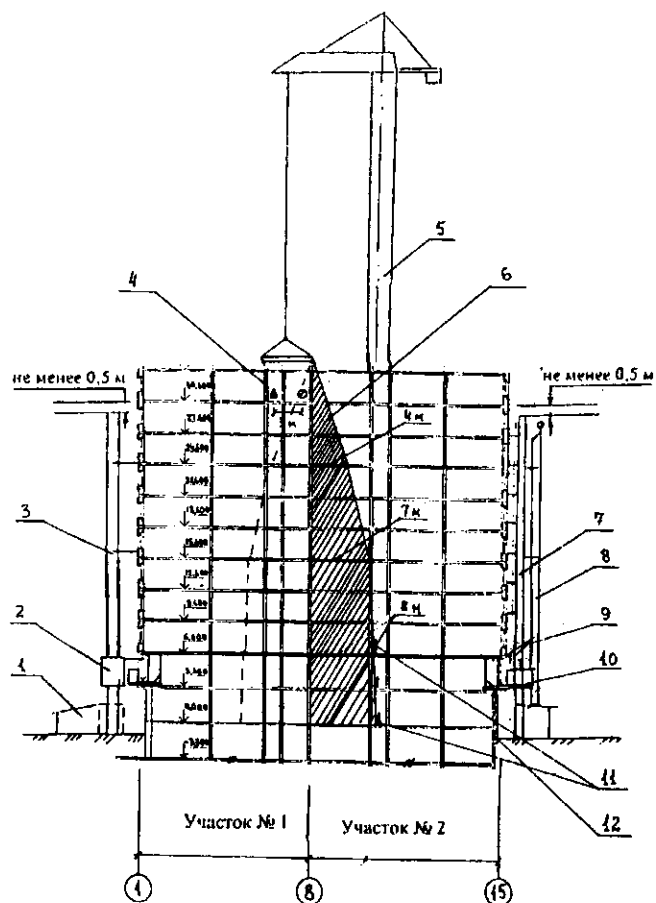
Схема опасной зоны от возможного падения груза при работе крана
